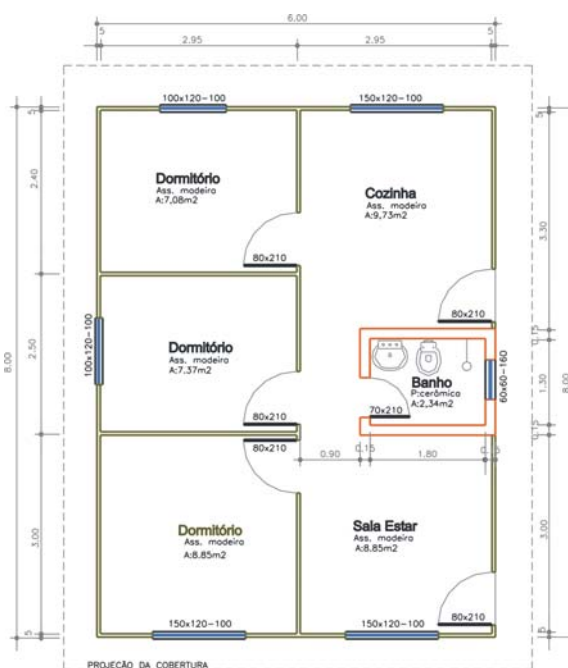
Vedações em Madeira - Planta Baixa – Área: 48,00 m²
